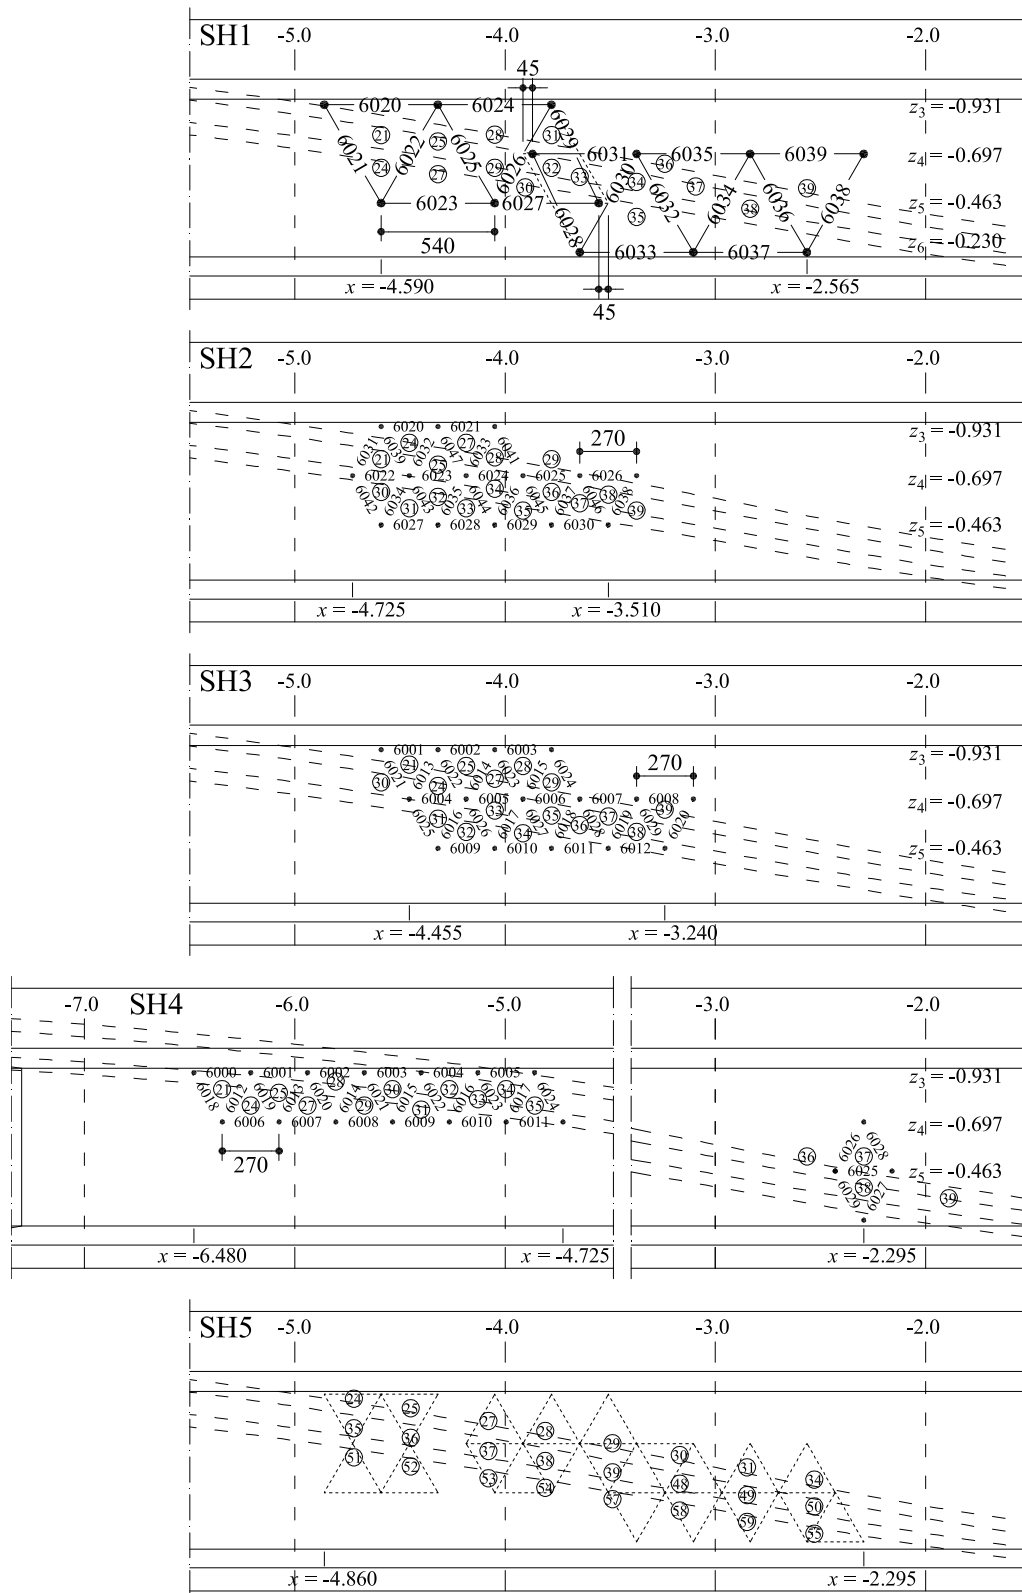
Poutres SH1 à SH5, partie Nord : emplacement des capteurs dans la zone susceptible de rupture mesurant l'allongement local du béton de l'âme et la fissuration interne dans le plan de l'âme
